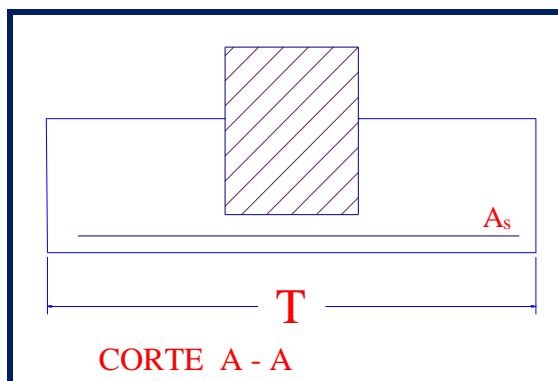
Modelamiento de zapata en elevación, zapata conectada corte A-A.
